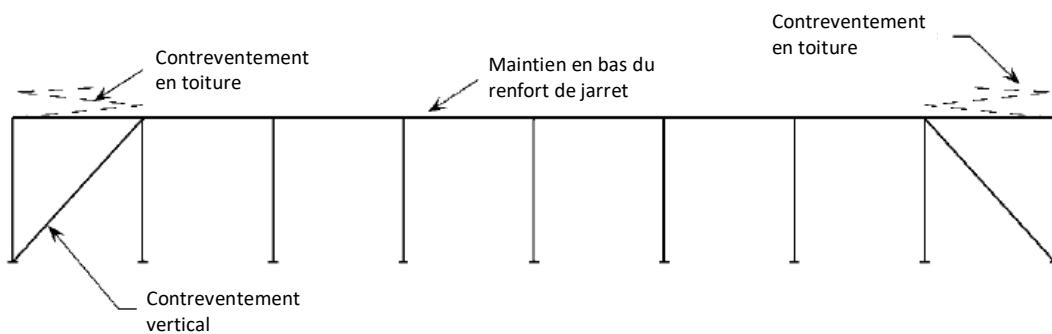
Disposition typique d'un contreventement vertical (figure traduite de [5])
